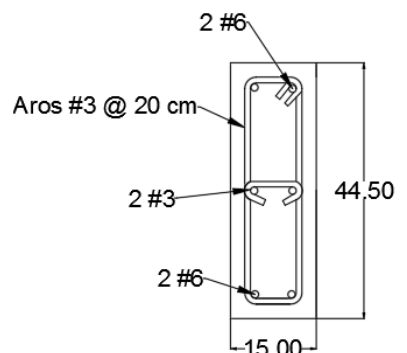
Detalle de viga corona muros RA.75, RA1, RA1.5 y RA2.
